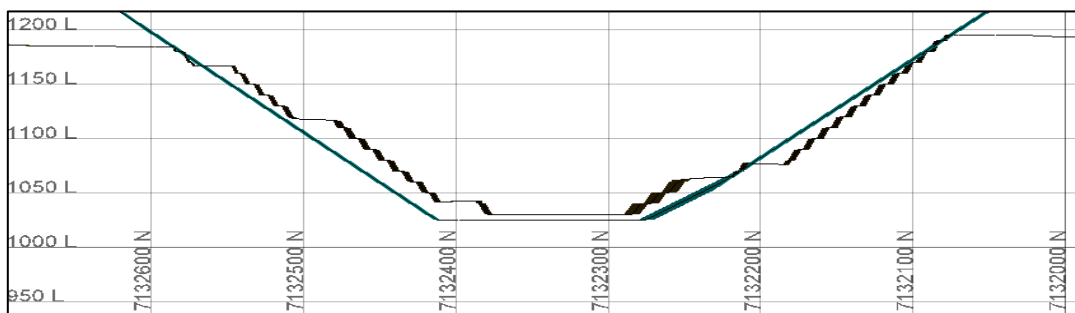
LGMM1Y Fase 2 - Vista en sección - Corte secundario N-S E394200
